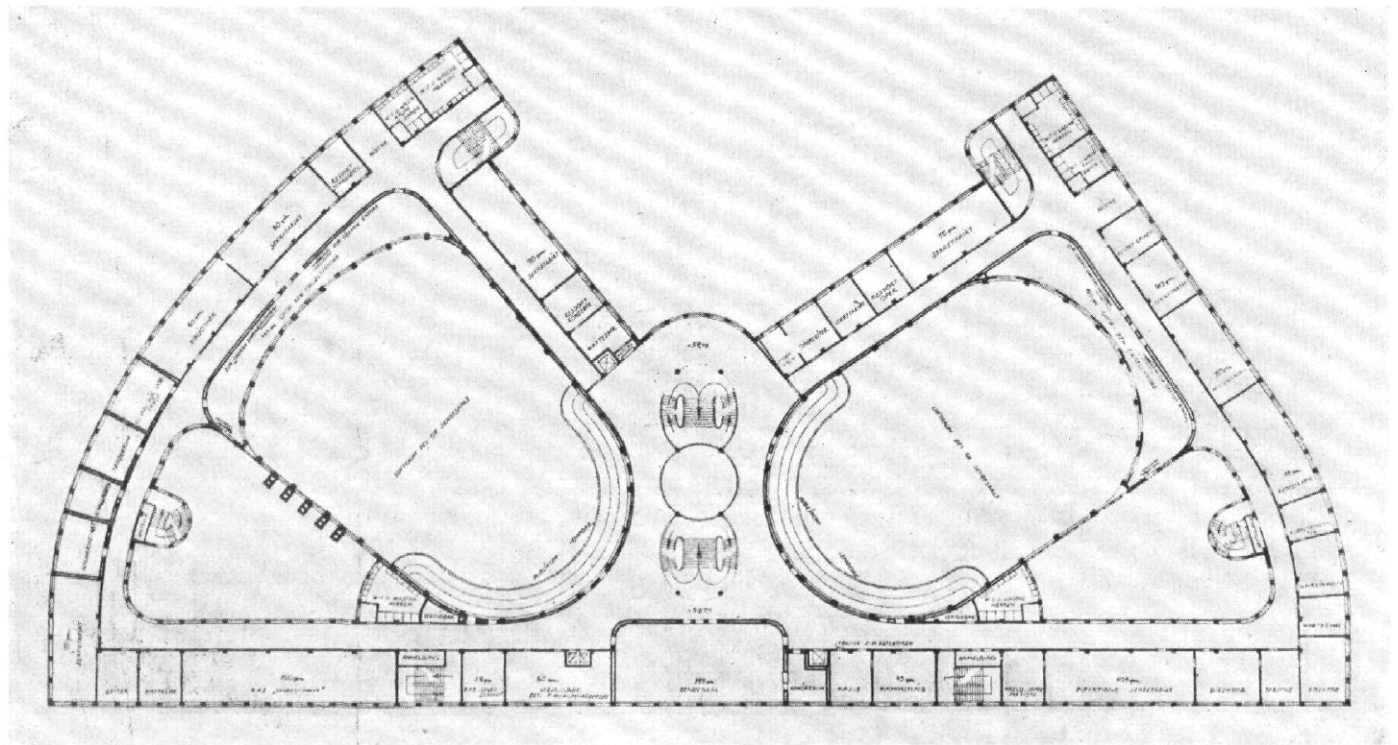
/ Mit dem ersten Preis ausgezeichnetem Entwurf für das Funkhaus in Berlin-Westend / Architekt: Hans Poelzig, Berlin / Grundriß 1 : 1200
